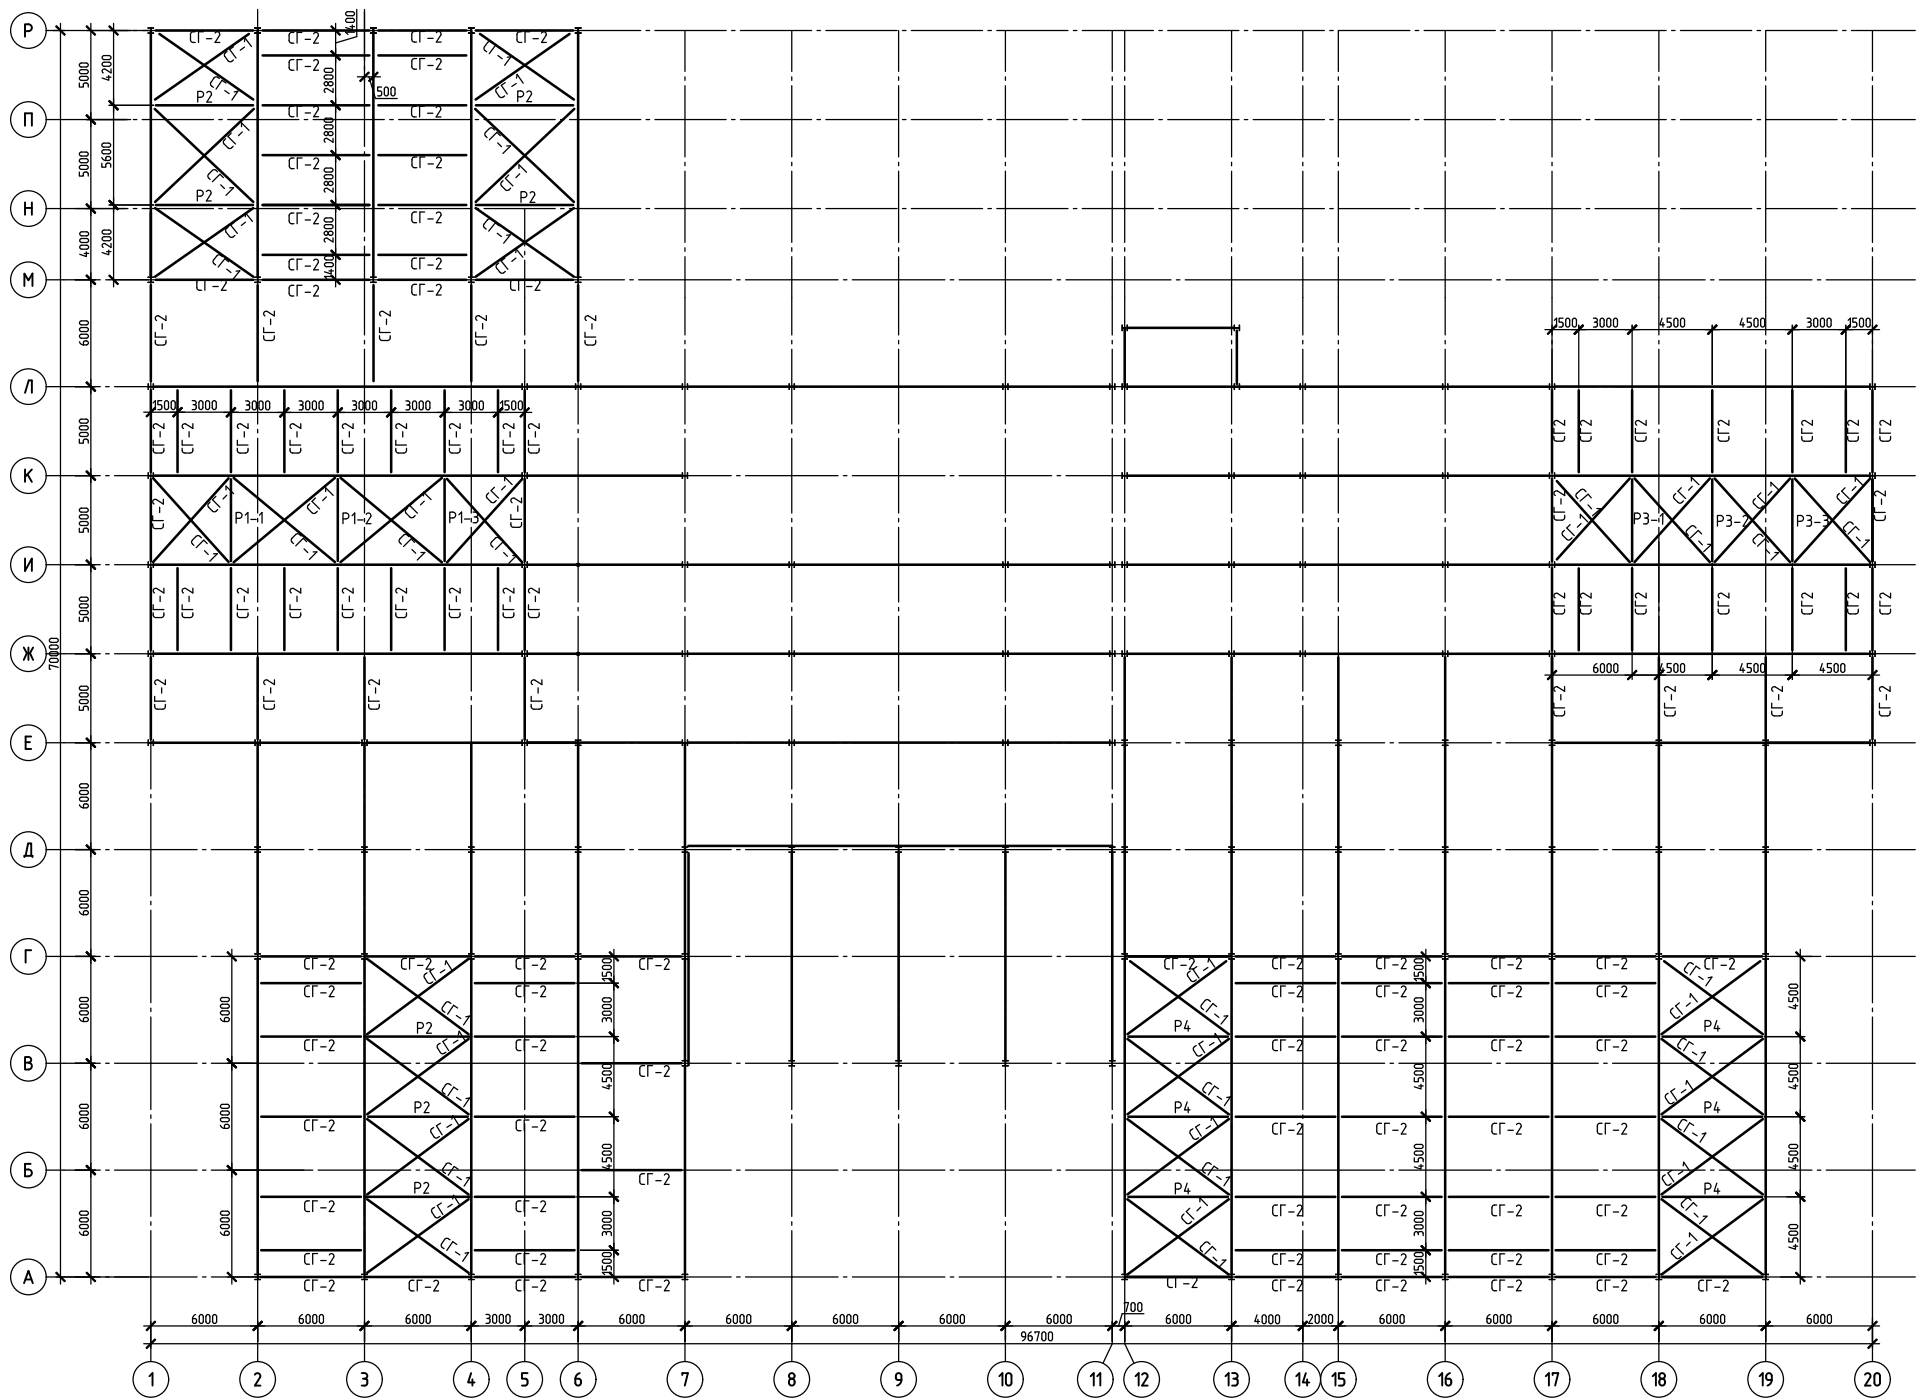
Связи по нижним поясам стропильных ферм
